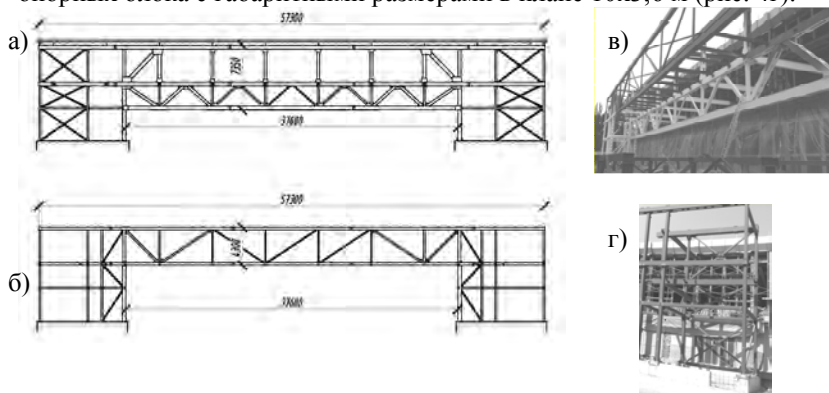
Конструктивная схема порталной решетчатой конструкции, где а - внутренняя ферма; б - ферма с фасада пристройки; в - решетчатая пролетная конструкция; г – опорный блок
